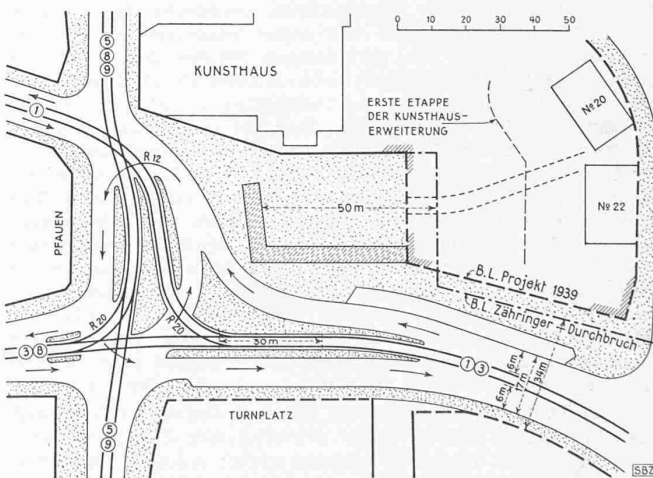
Anordnung der Strassenbahn-Linie 1 mit Minimalradius und Kunsthaus-Vorhof mit Fussgänger-Durchgang, 1:2000
